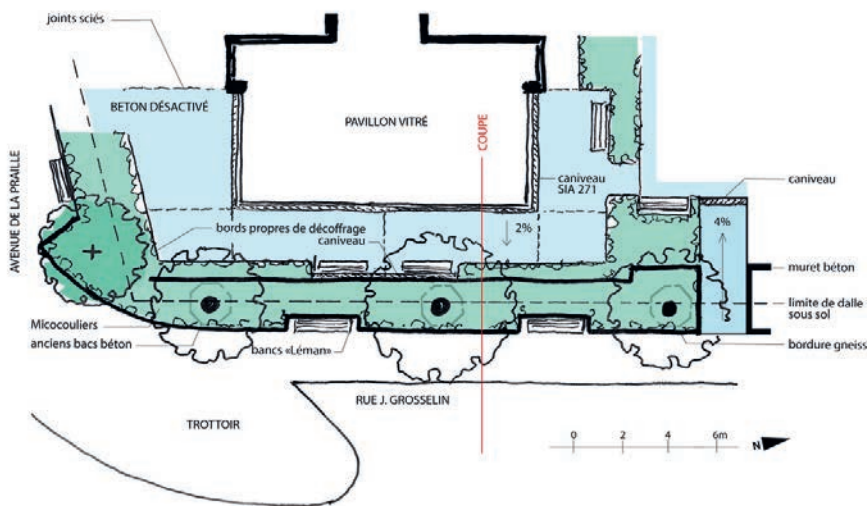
Les Pervenches, plan espace jardiné. dessin: Jacquet SA / E. Amos & B. Goyard
